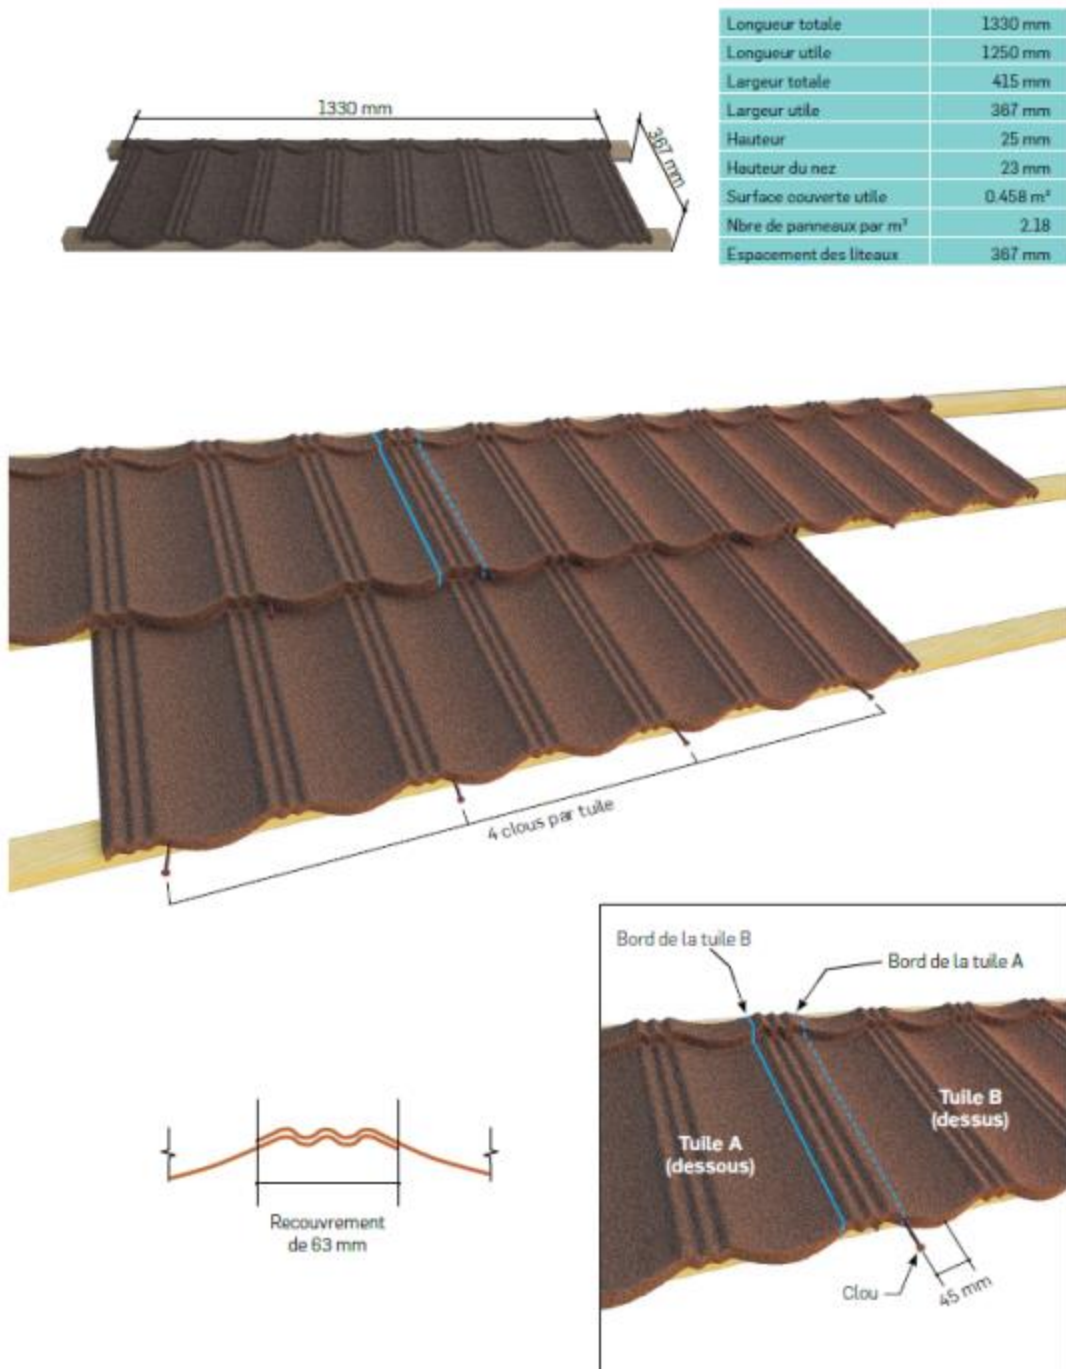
Tuile « GERARD HERITAGE », dimensions, clouage et recouvrement
